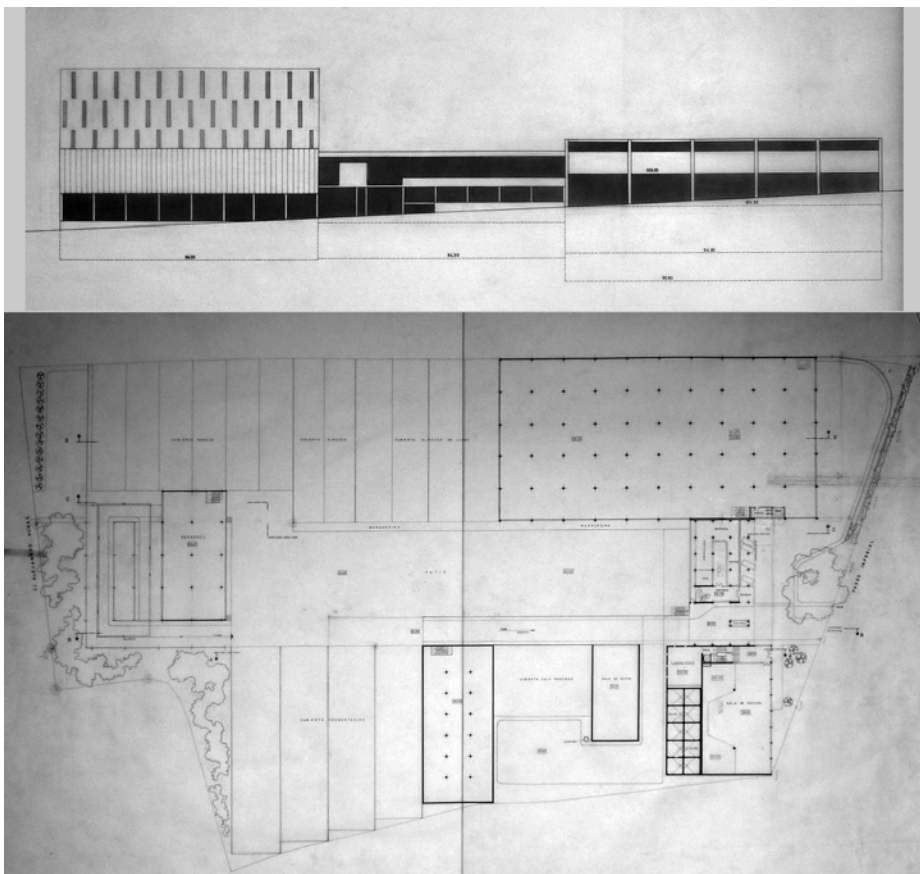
Fábrica Mahou. Planta general y alzado del anteproyecto, 1961 (Servicio Histórico COAM)
